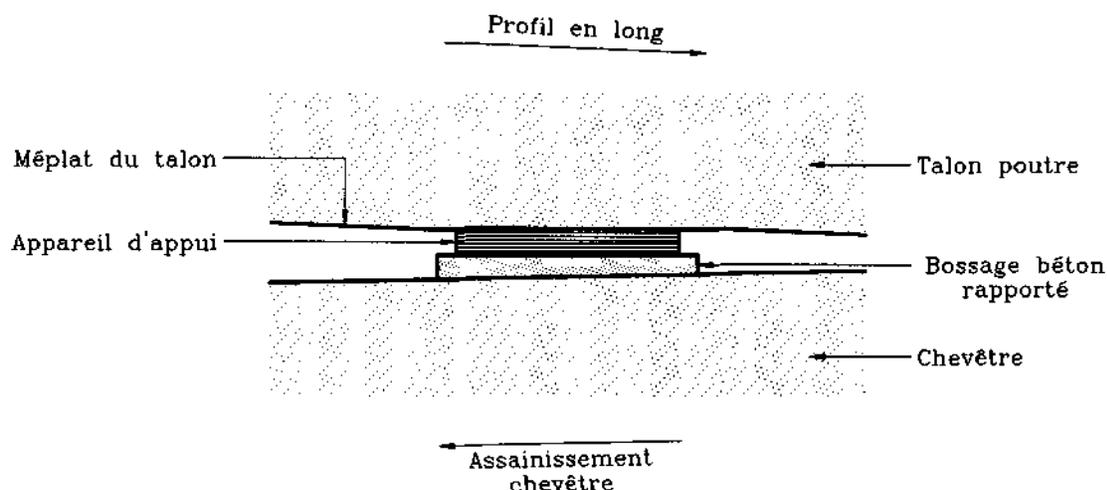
Cas 1 - Méplat de la fibre inférieure du talon
